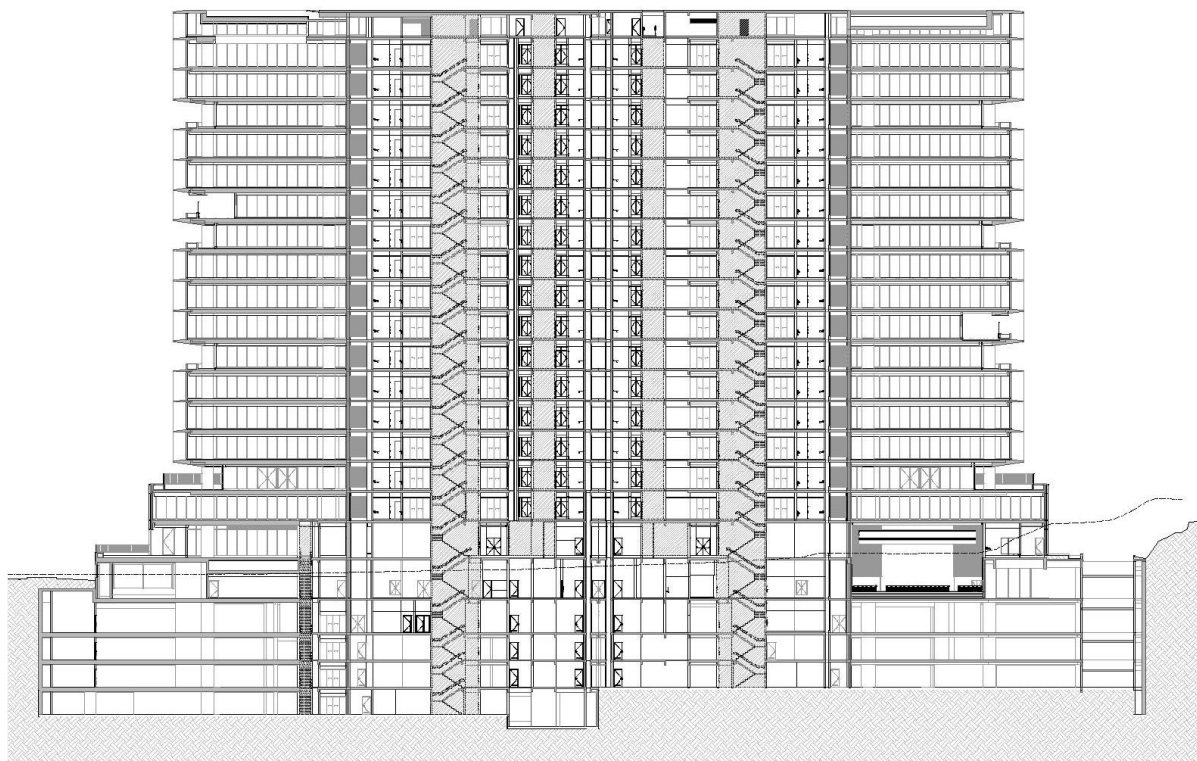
Corte AA do Edifício Lótus Tower (sentido norte-sul).
